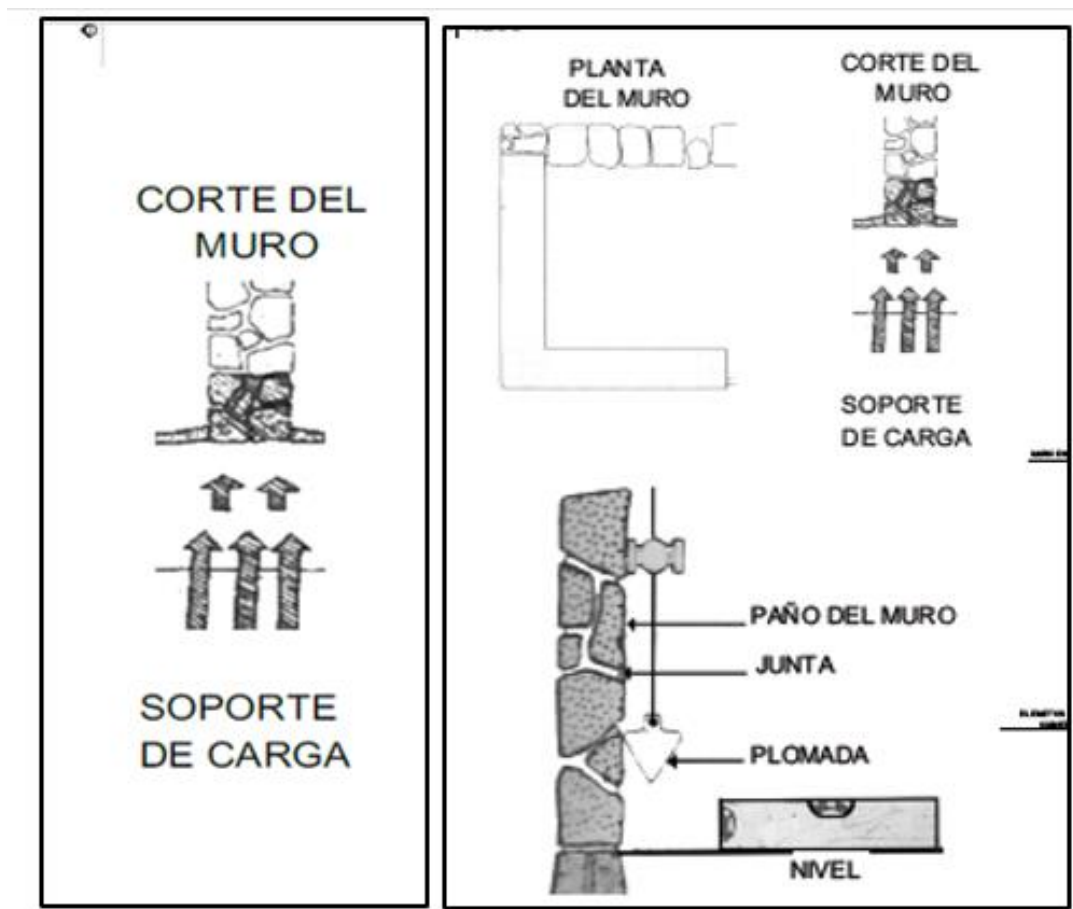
Detalle del sistema de muros del primer piso y sistema de cimiento. Fuente propia
